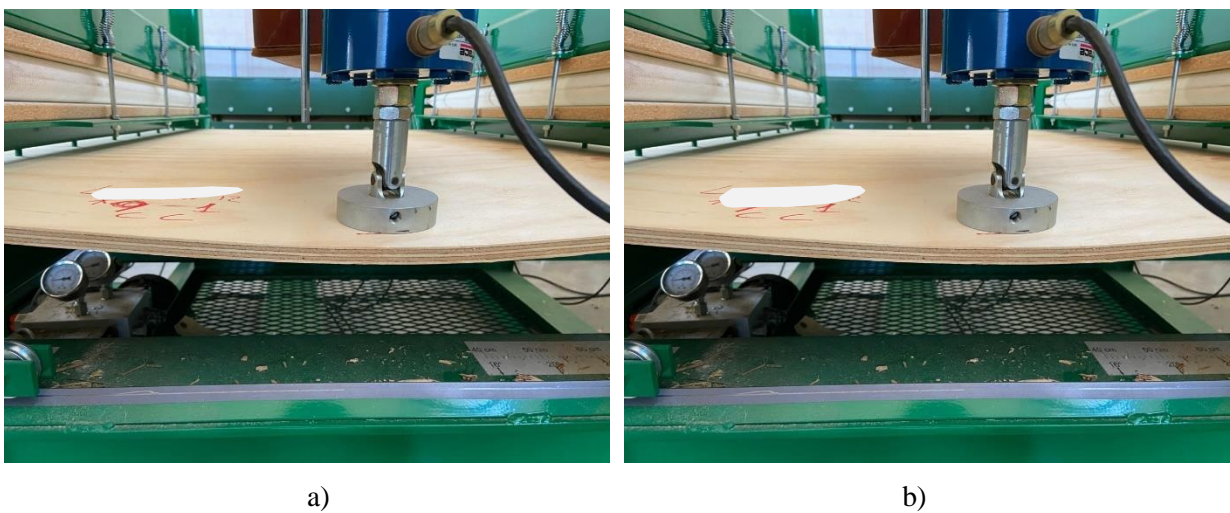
Ensayo carga estática concentrada. a) vista 1 b) vista 2.
